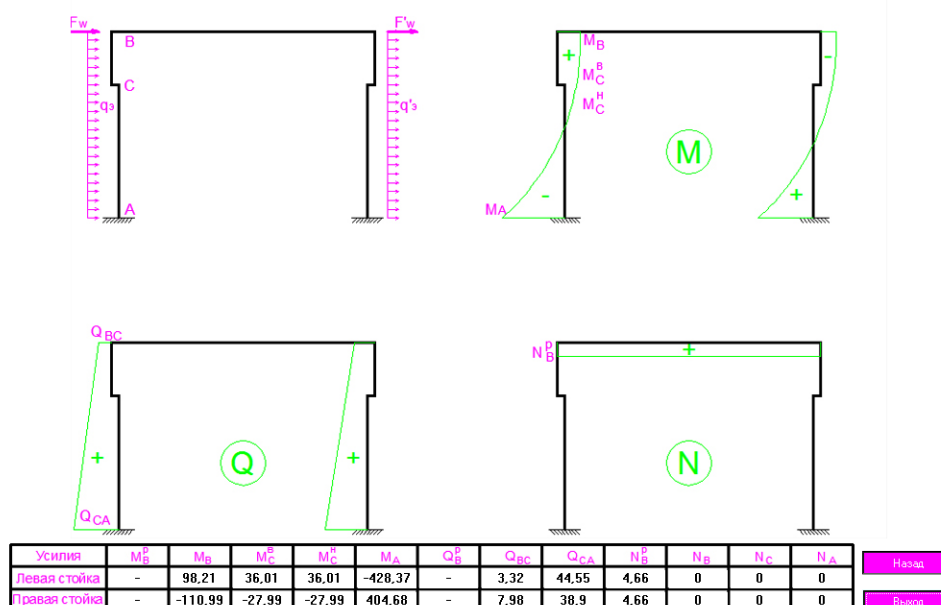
Эпюры усилий от ветровой нагрузки
